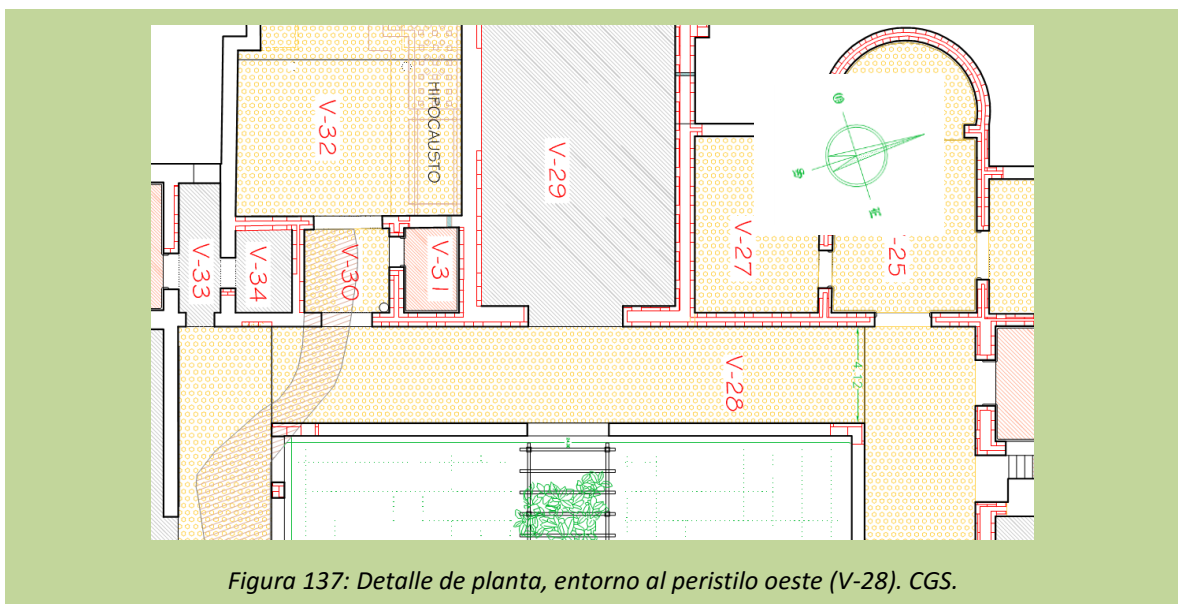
Detalle de planta, entorno al peristilo oeste (V-28). CGS.
